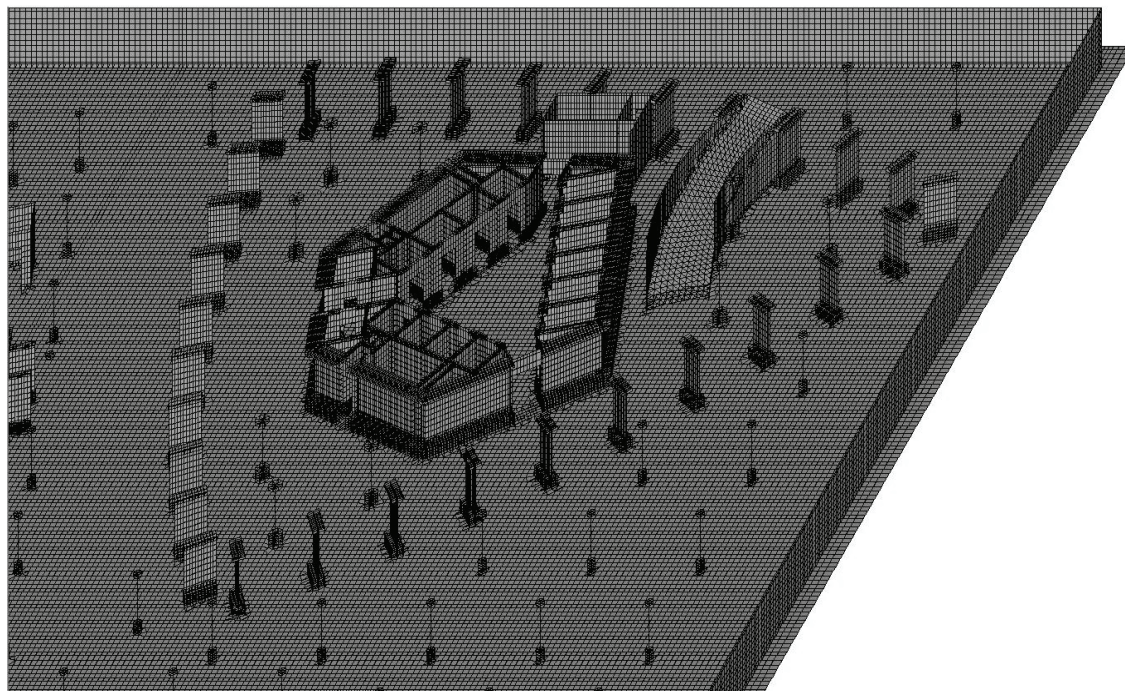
Схема моделирования узлов соединения стен и колонн с фундаментной плитой.
